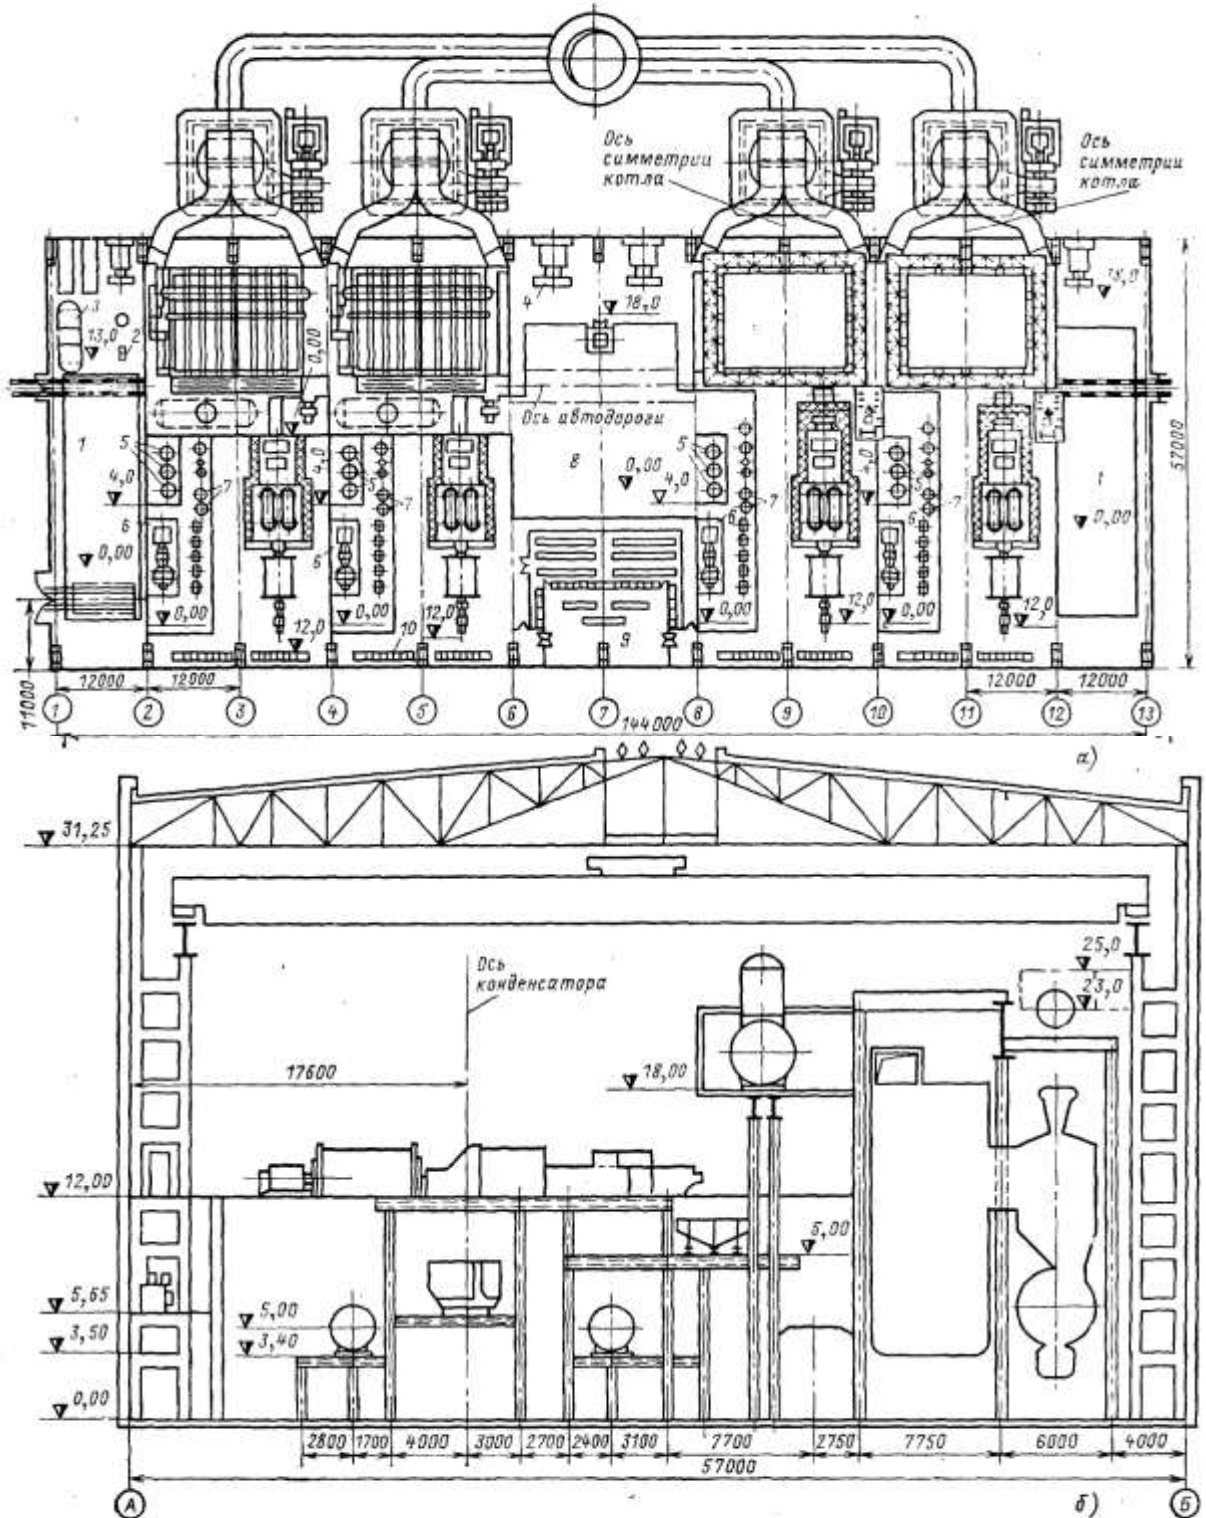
Компонировка главного корпуса ТЭЦ-ЗИГМ с малогабаритными котлами:
